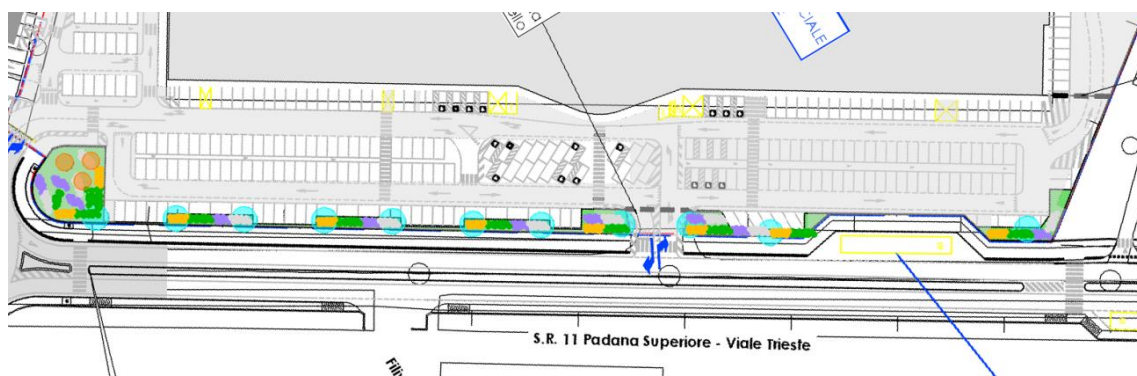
estratto della tavola P.2.3.2 Planimetria Generale fronte negozio
